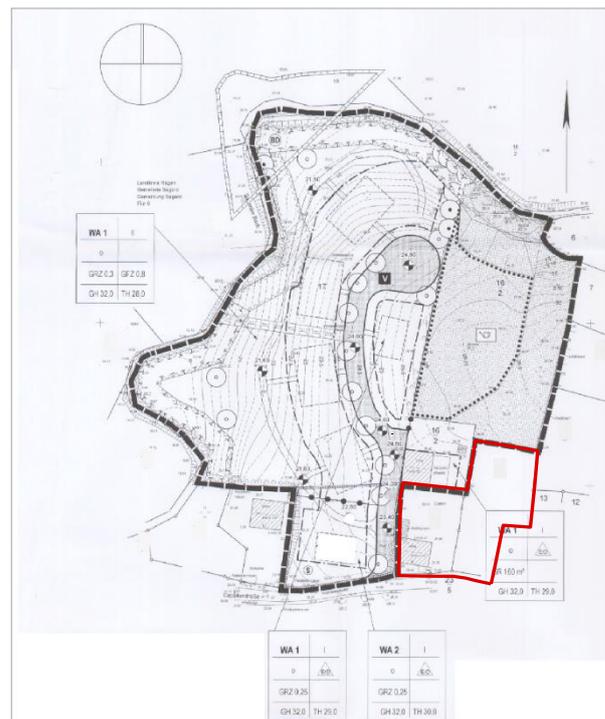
Ursprungsplan, Planzeichnung ohne Maßstab
